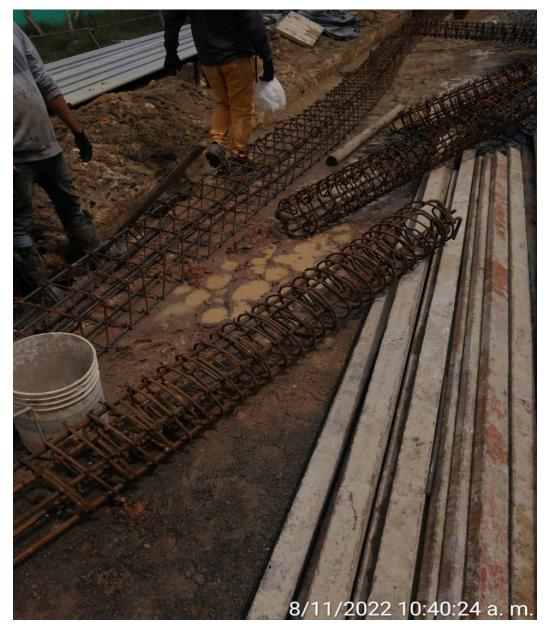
Acero para construcción de viga de cimentación del cerramiento perimetral.
